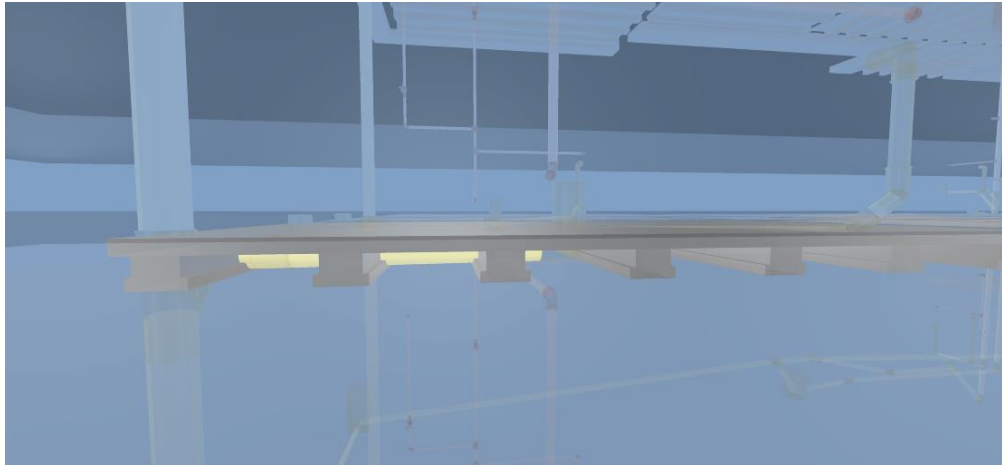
COLISÃO ENTRE TUBULAÇÃO E VIGA BALDRADROME
